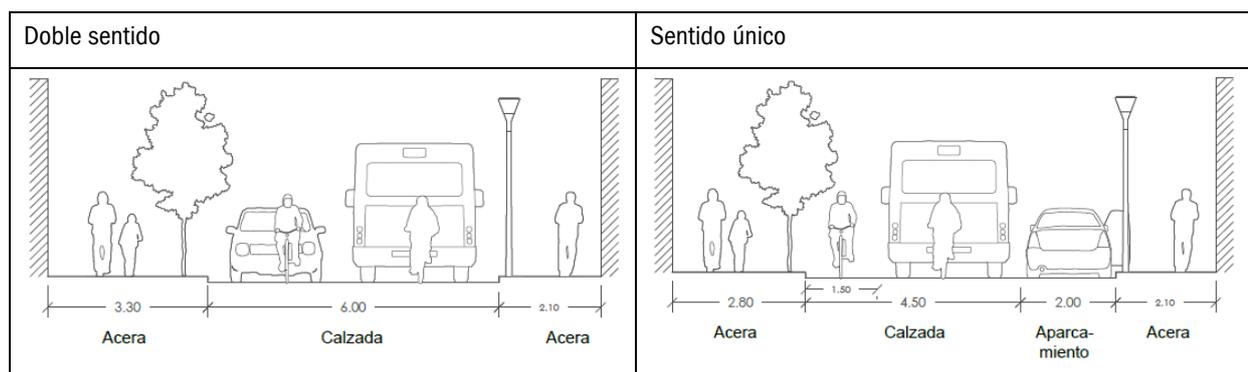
SECCIÓN PROPUESTA PARA EL TRAMO A3
